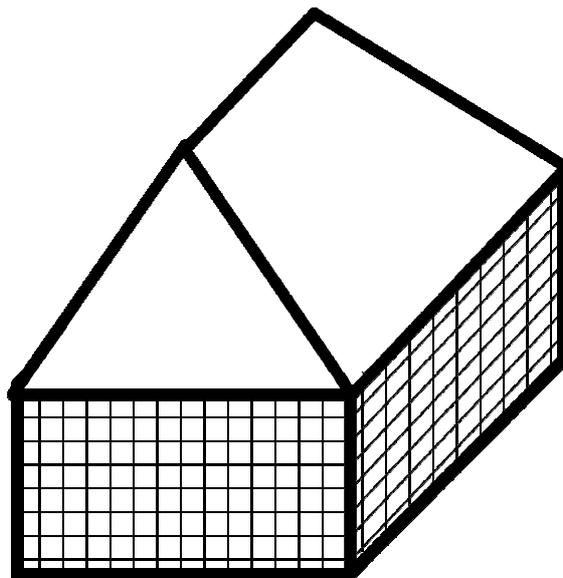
Estrutura base da construção de uma casa de taipa de mão.
